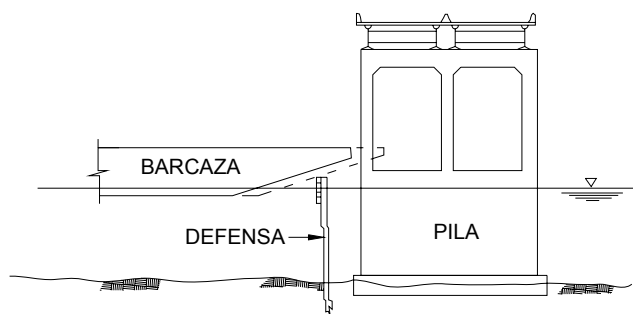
Vista en elevación de una saliente de la proa de una barcaza impactando contra una pila
